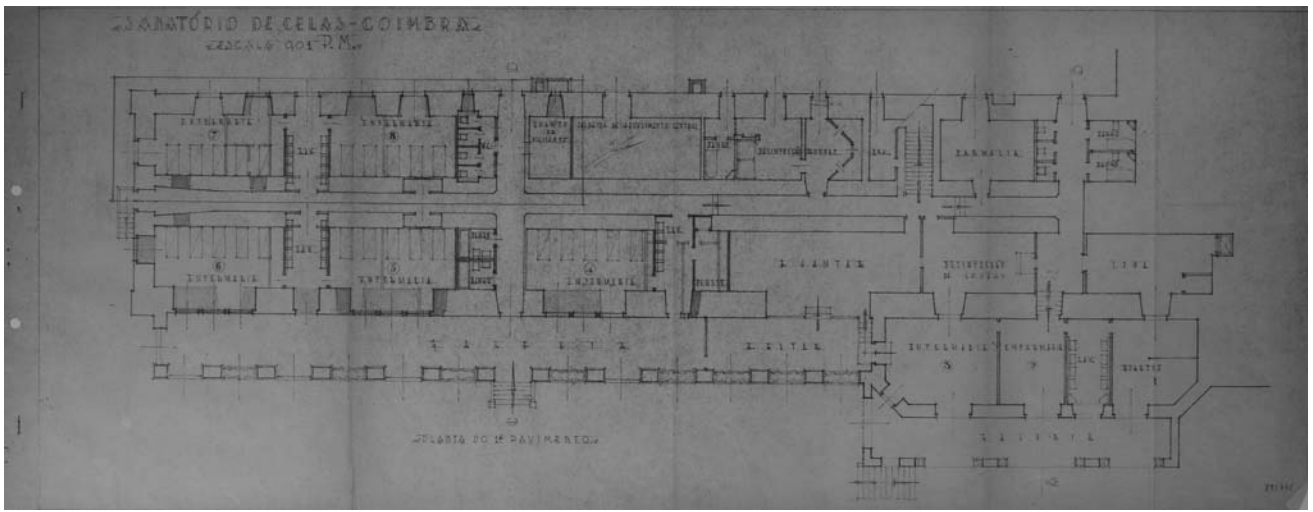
Sanatório de Celas - Planta do 1º Pavimento. 1953. 1953(m.). SIPA: DES\_815775.
